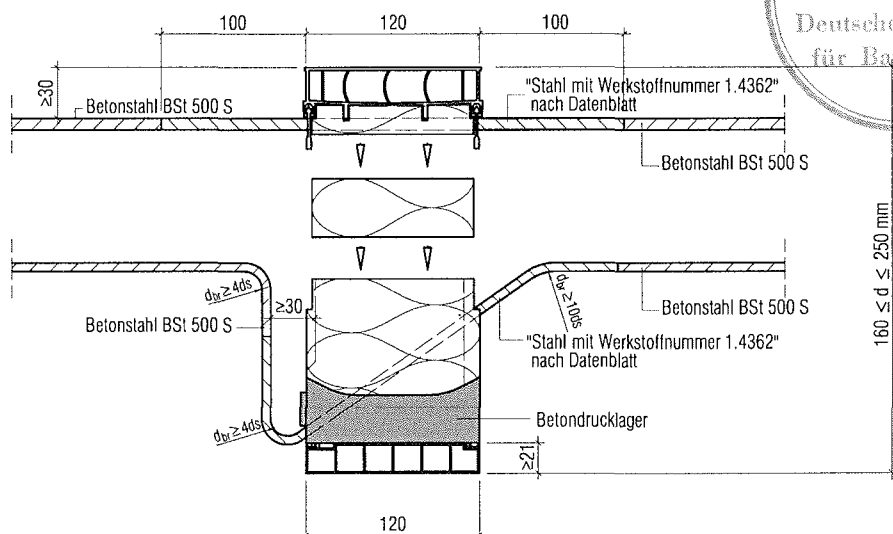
Schöck Isokorb Typ KF mit Druck- Querkraft Kombination und integrierter Aufhängebewehrung
